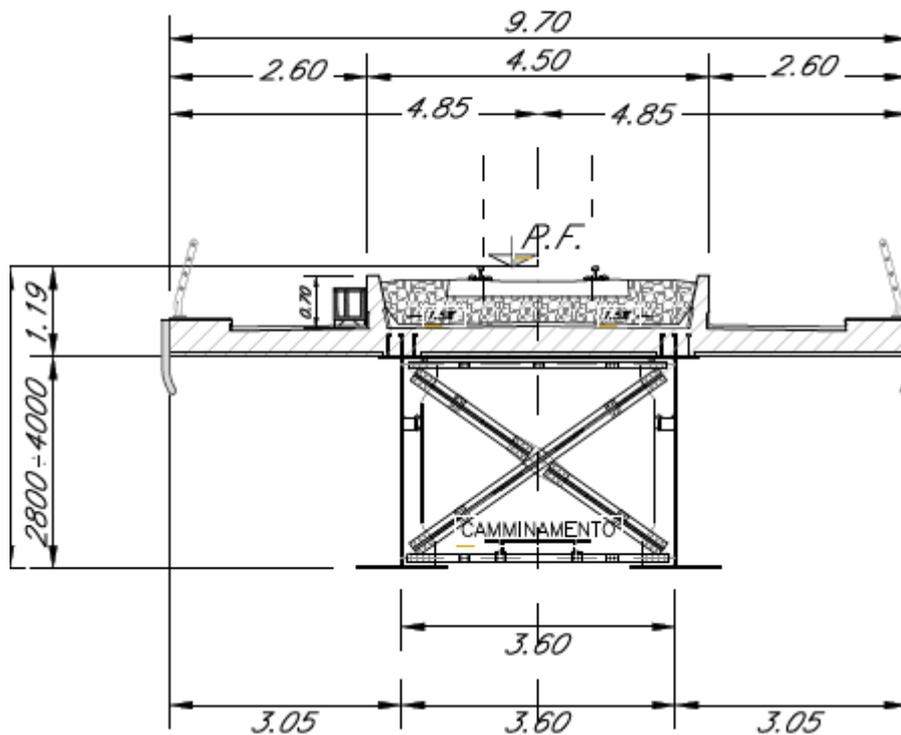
sezione trasversale dell'impalcato misto acc-clc 50m
